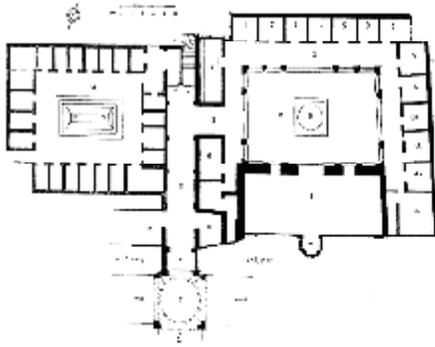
مسقط أفقي للطور الأرضي لمدرسة الصغارين
